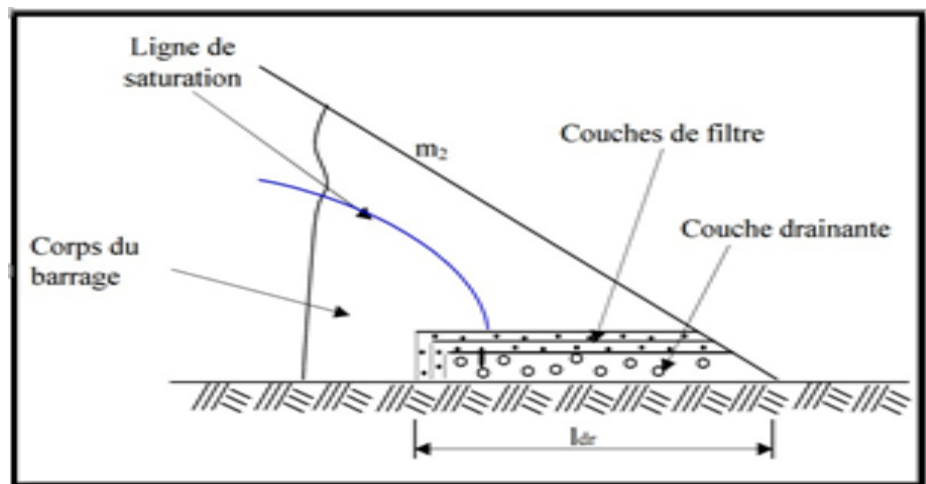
coupe d'un tapis de drainage (source : site planete-tp)
